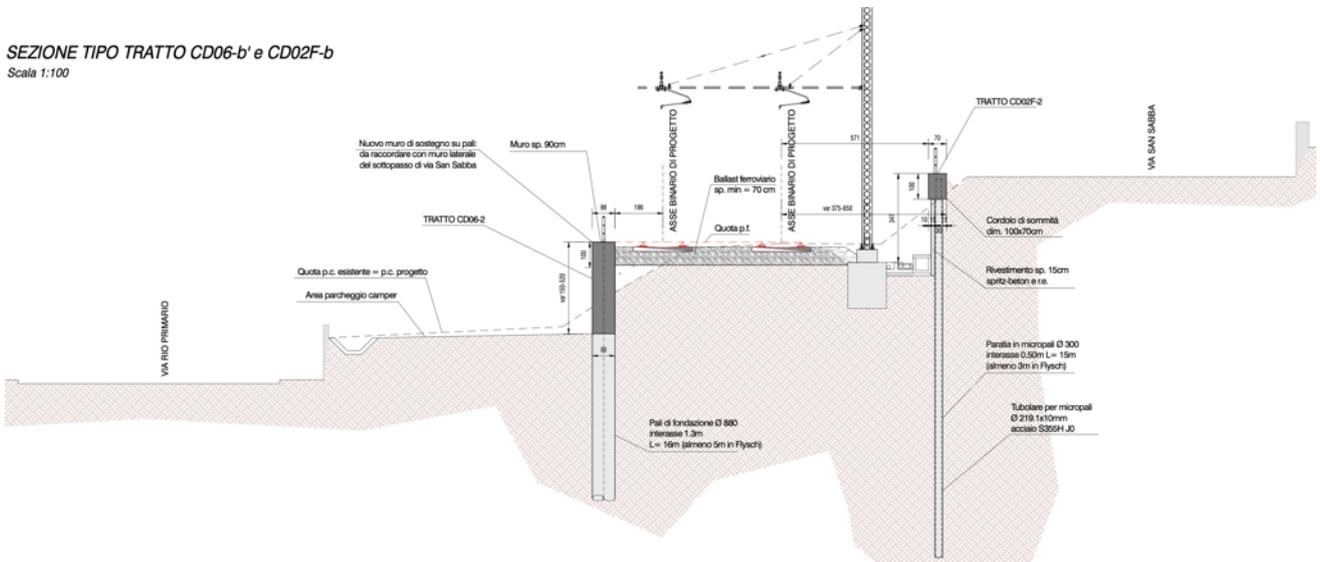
sezione tipo tratti CD06-b' e CD02F-b, subito a S-E rispetto via Rio Primario
